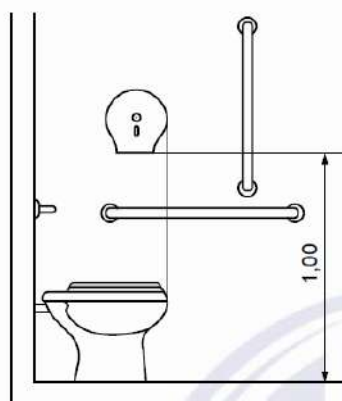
Localização da papelreira de sobrepor (rolo) – Vista lateral
